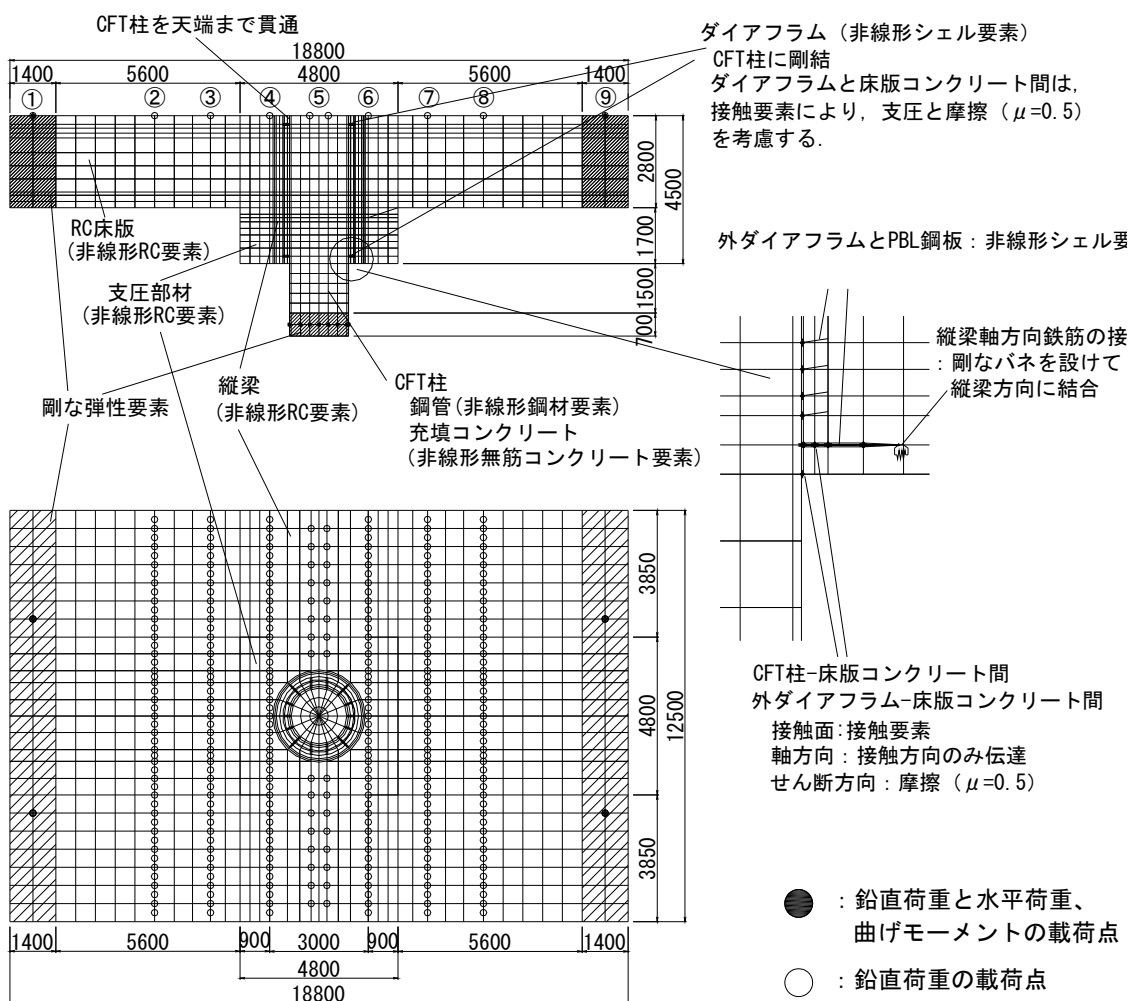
改善提案した T 字接合構造の FE モデル (単位 : mm)
